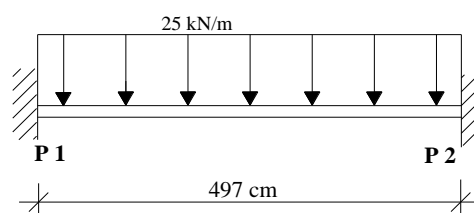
Esquema estático e carregamento no vão da viga adjacente ao pilar P1.
